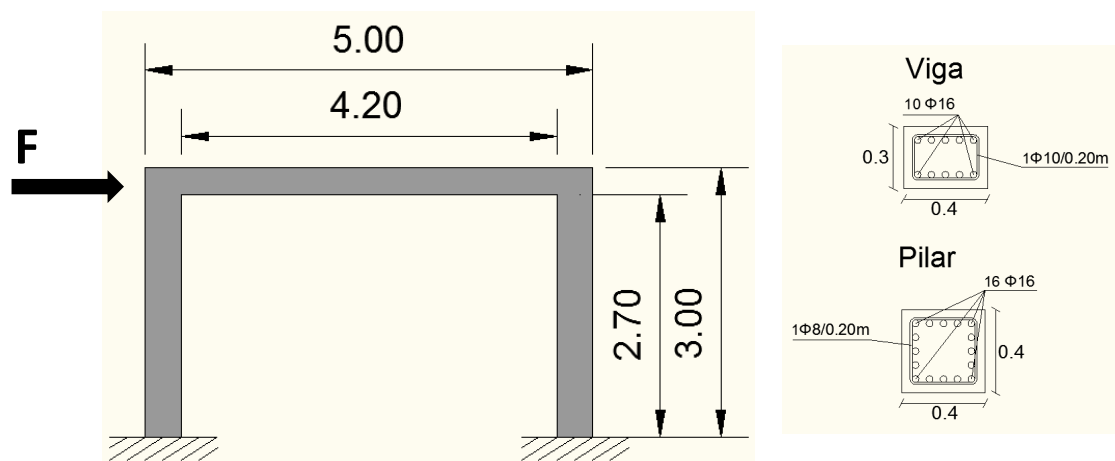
Geometría tipo del pórtico (todas las unidades en metros, excepto los diámetros de las barras, en milímetros) [32]
